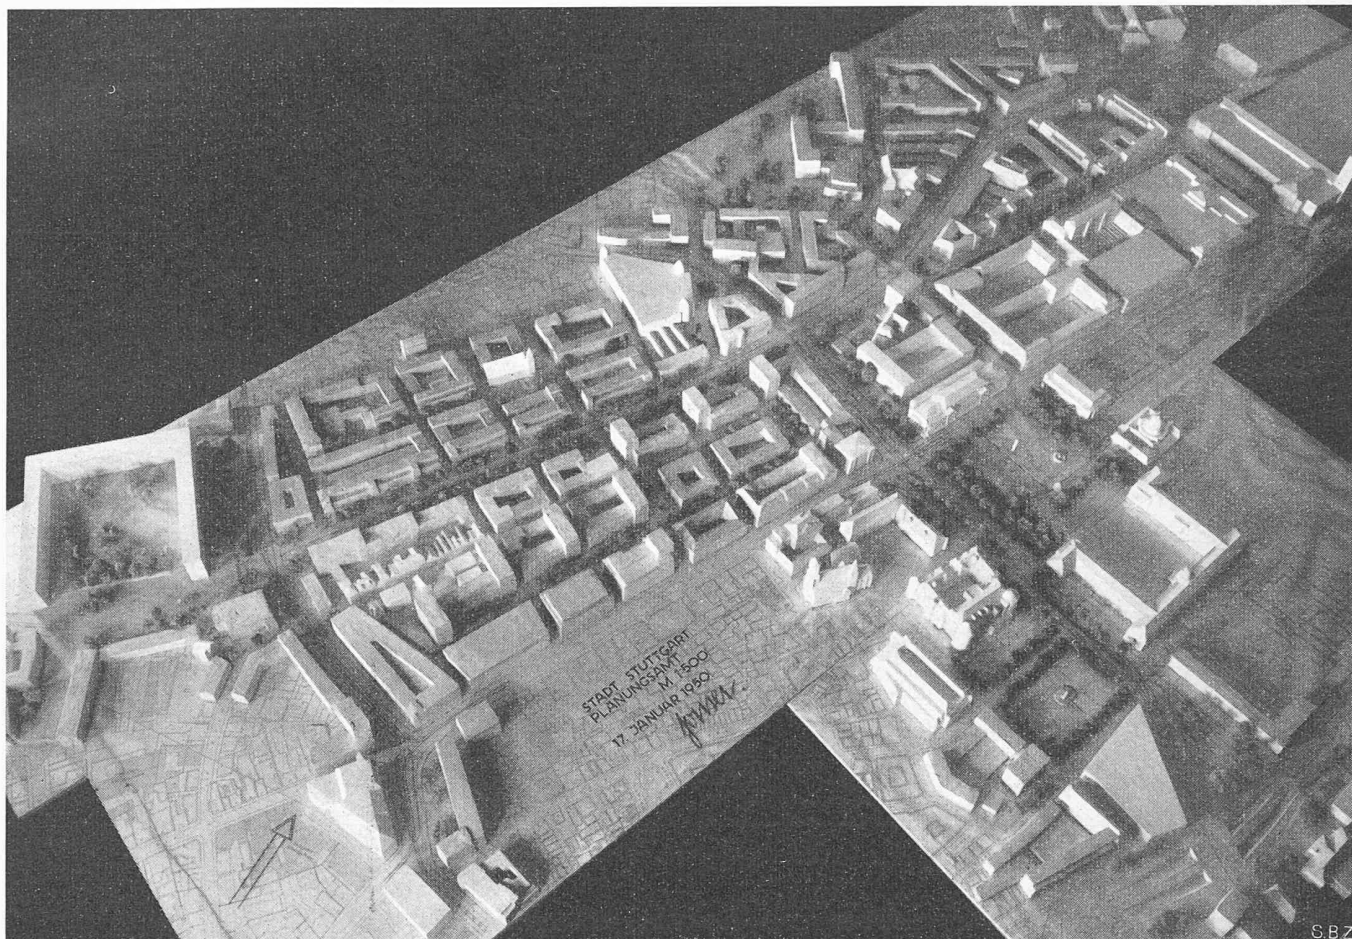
Stuttgart. Der Rote Strasse-Durchbruch zwischen Bahnhofbau (rechts) und der ehemaligen Rötebühlkaserne (links). In Bildmitte die Königstrasse, rechts davon altes und neues Schloss, «Planie» und Charlottenplatz (mit projektierte Unterführung). Entwurf: Städtisches Planungsamt
